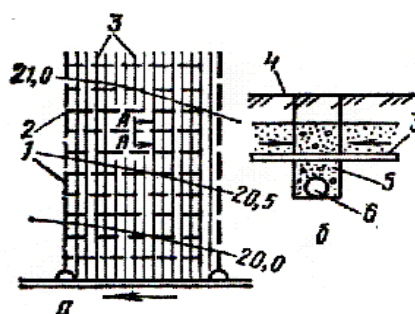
Схема осушения дренами в сочетании с кротованием: а – план; б – разрез по А-А; 1 – коллектор; 2 – закрытые дренажи; 3 – кротовины; 4 – пахотный слой почвы; 5 – засыпка; 6 – дренажная труба
